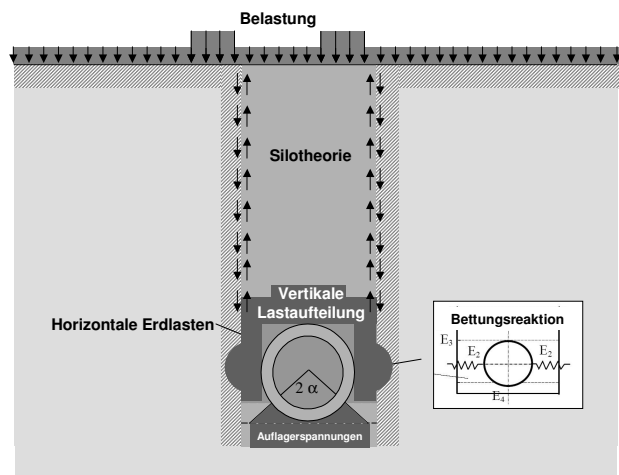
Rohr-Boden-System in offener Bauweise, Modellvorstellungen
